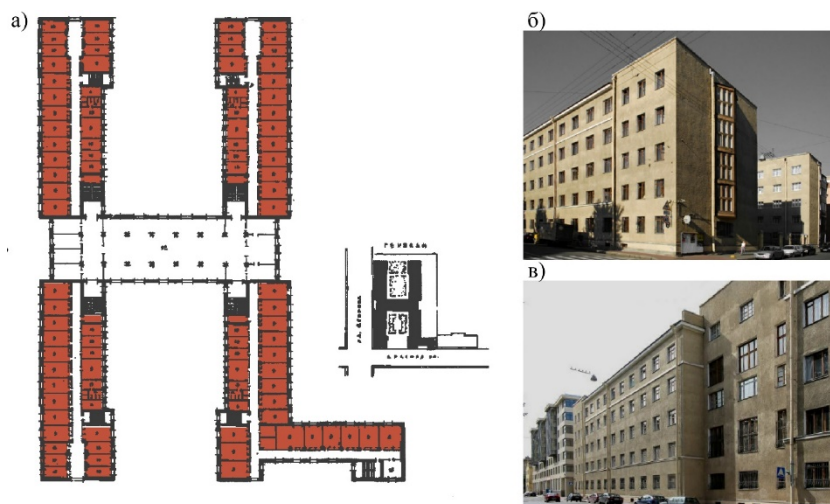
Общежитие ЛИИЖТ г. Ленинград 1939 г. (а – план типового этажа, б и в - фасад).
